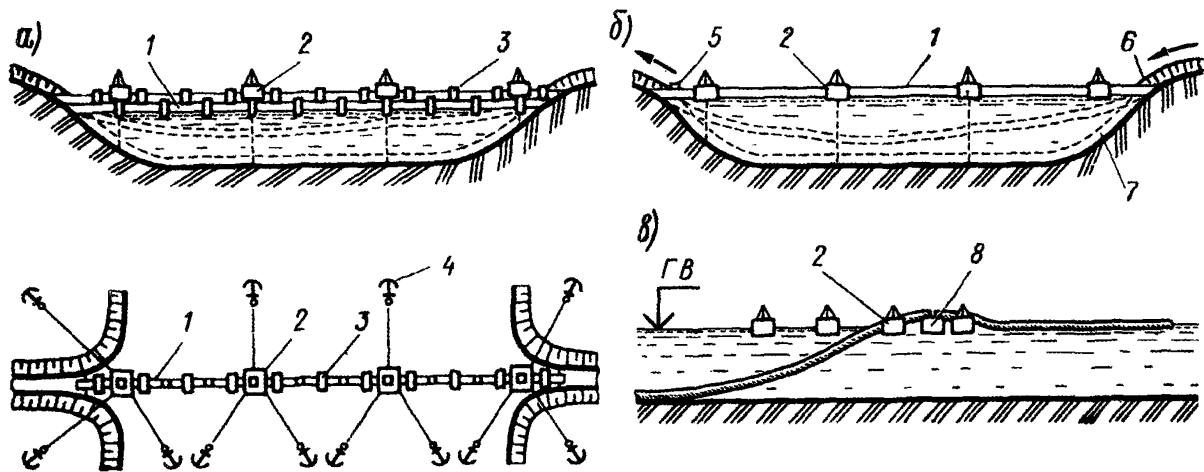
Схемы укладки трубопровода с плавучих опор:
